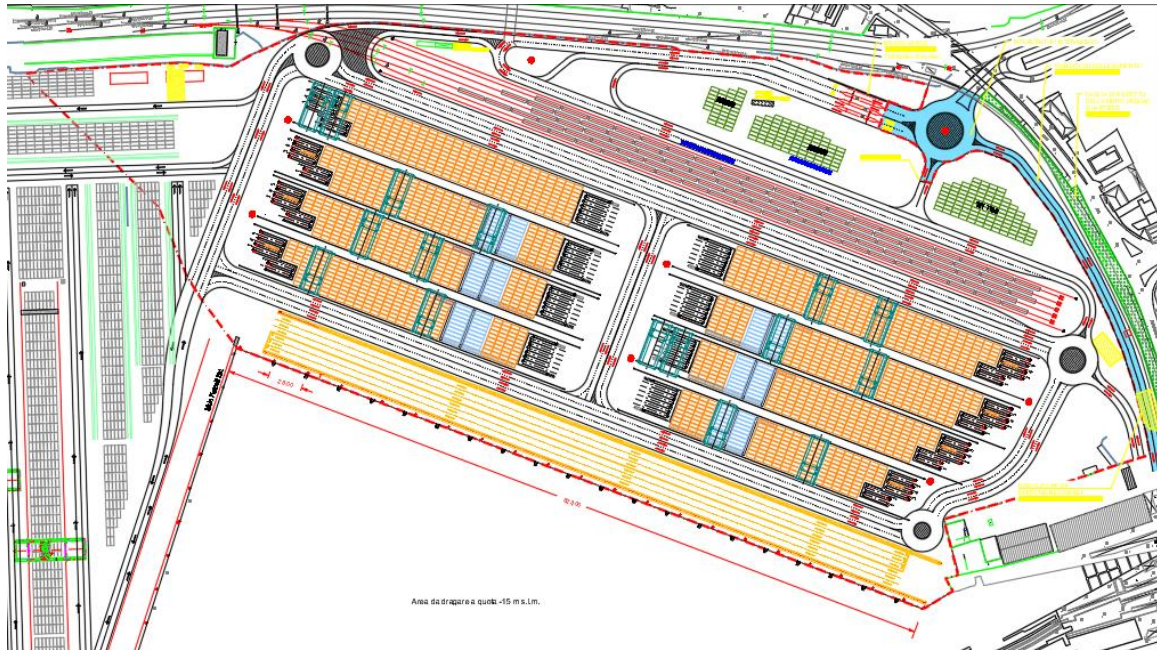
Nuovo terminal Ravano – Possibile layout alternativo
